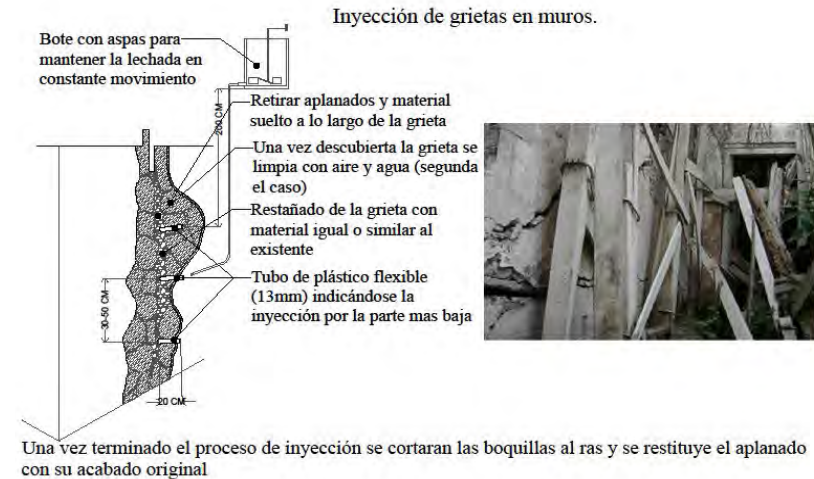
Inyección de grietas en muros fig.25 (Gonzalez, et. al, 1988, p.180).
